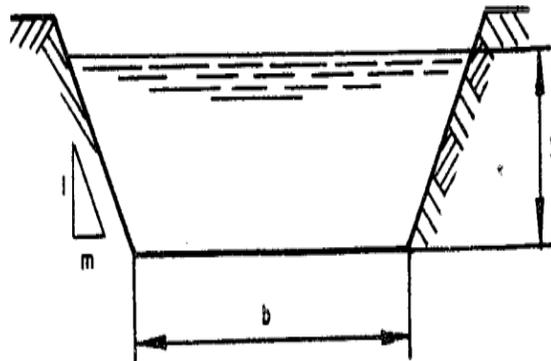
Geometría del canal trapezoidal y sus variables
